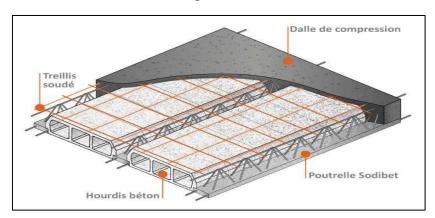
Schéma descriptif d'un plancher d'étage courant.
